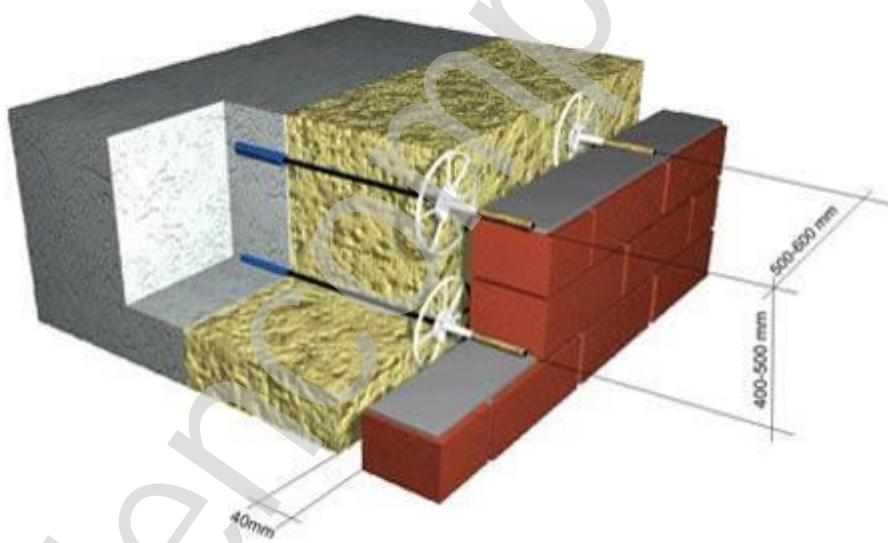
Схема трехслойной стены с базальтопластиковыми гибкими связями и бетонной несущей стеной
